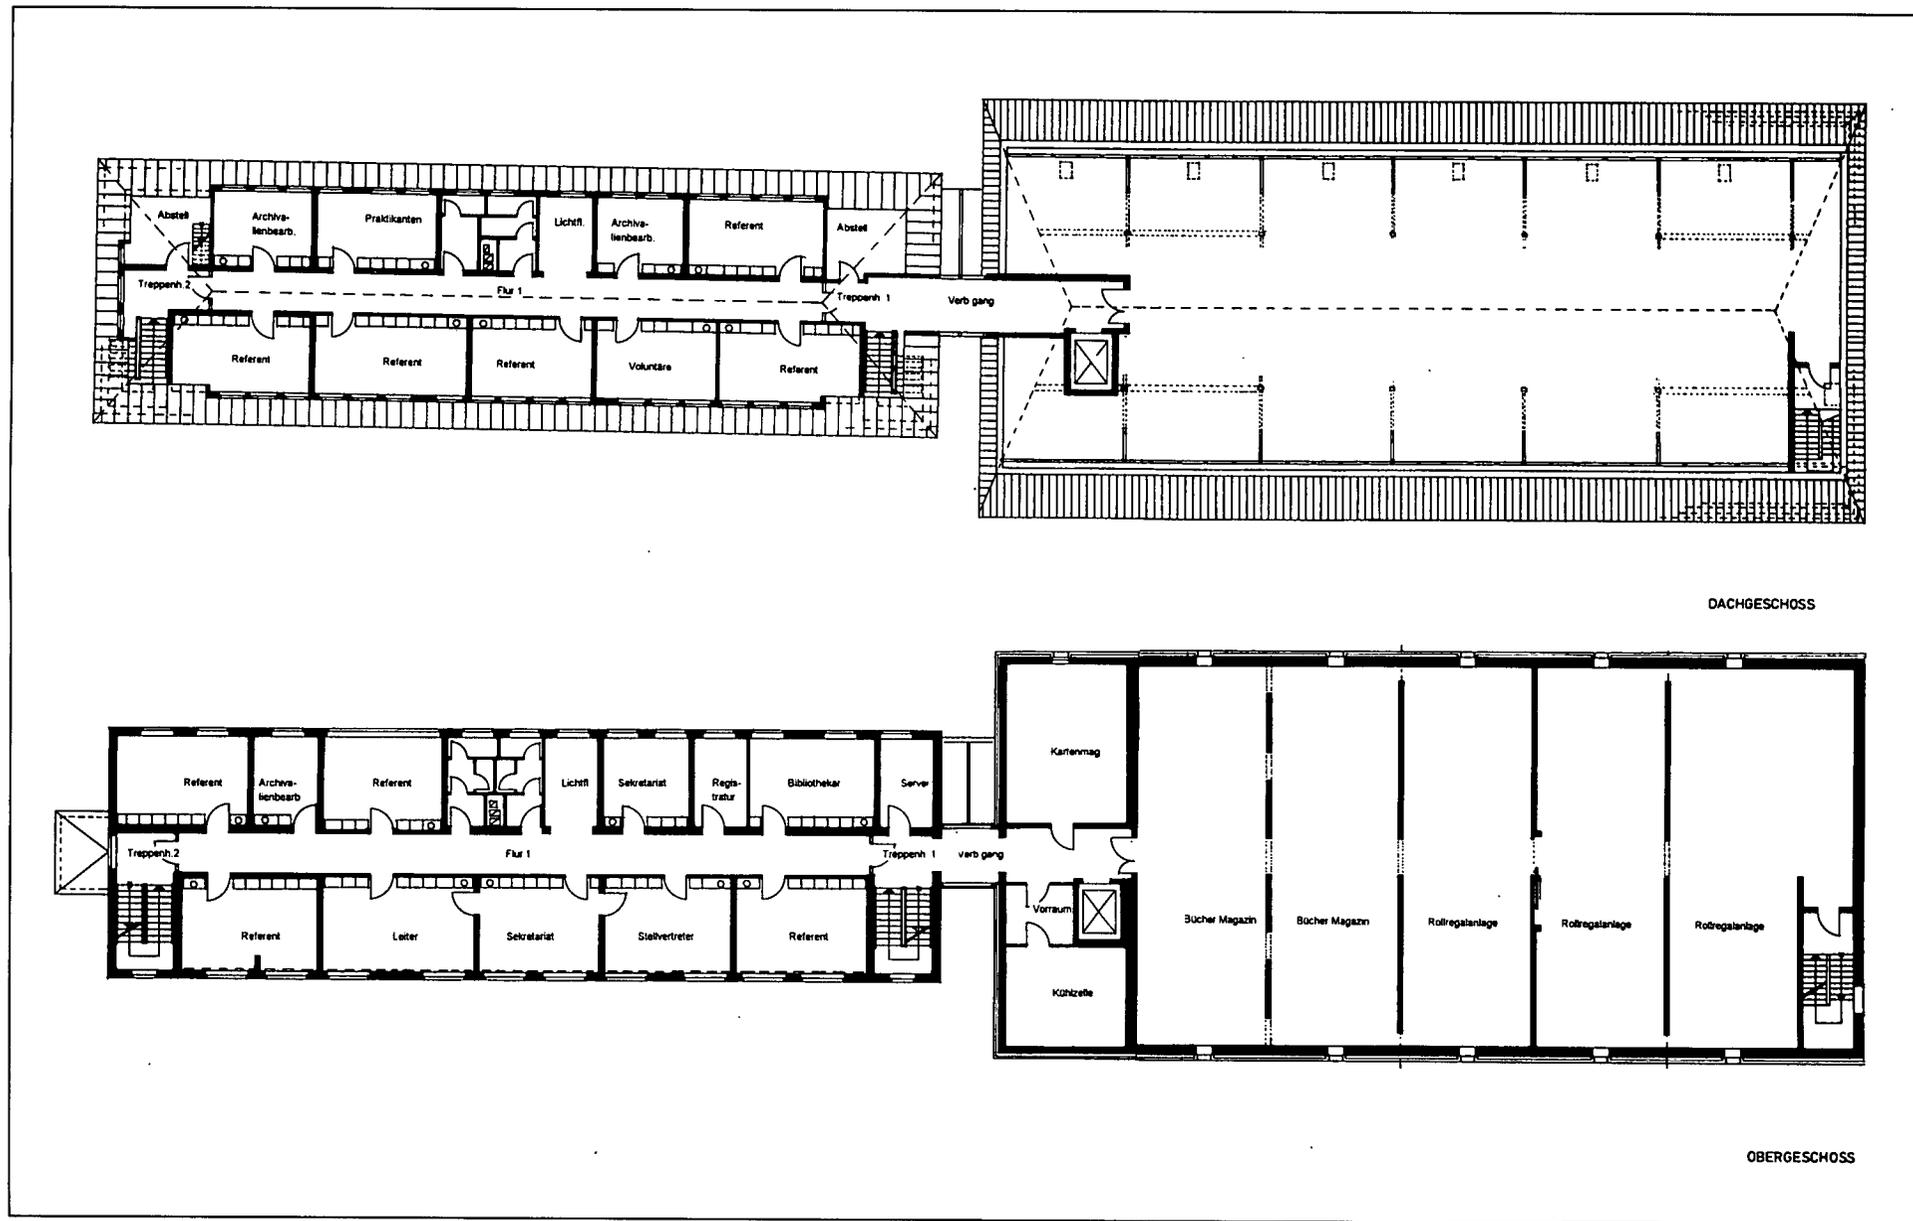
, 11: Neubau Westfälisches Archivamt - Grundrisse Ober- und Dachgeschoss
